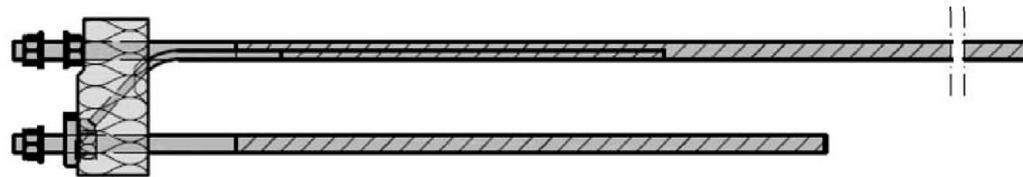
Schöck Isokorb® T Typ SK-MM2-VV1 und T Typ SK-MM2-VV2
